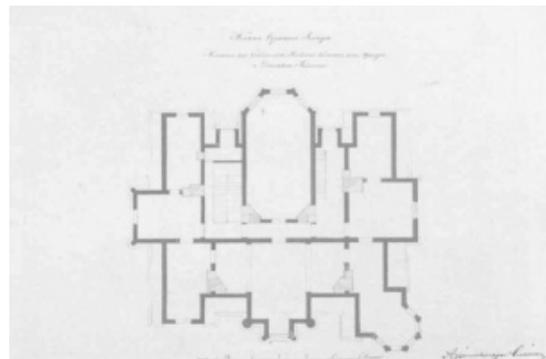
Skizze 9d, Grundriss obere Etage
